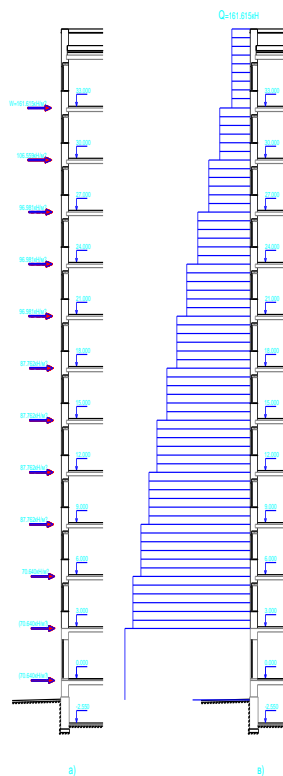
а) вітрове навантаження,по поверхам,на поперечну стіну;б) еюра поперечних сил  $Q$  по висоті поперечної стіни.
